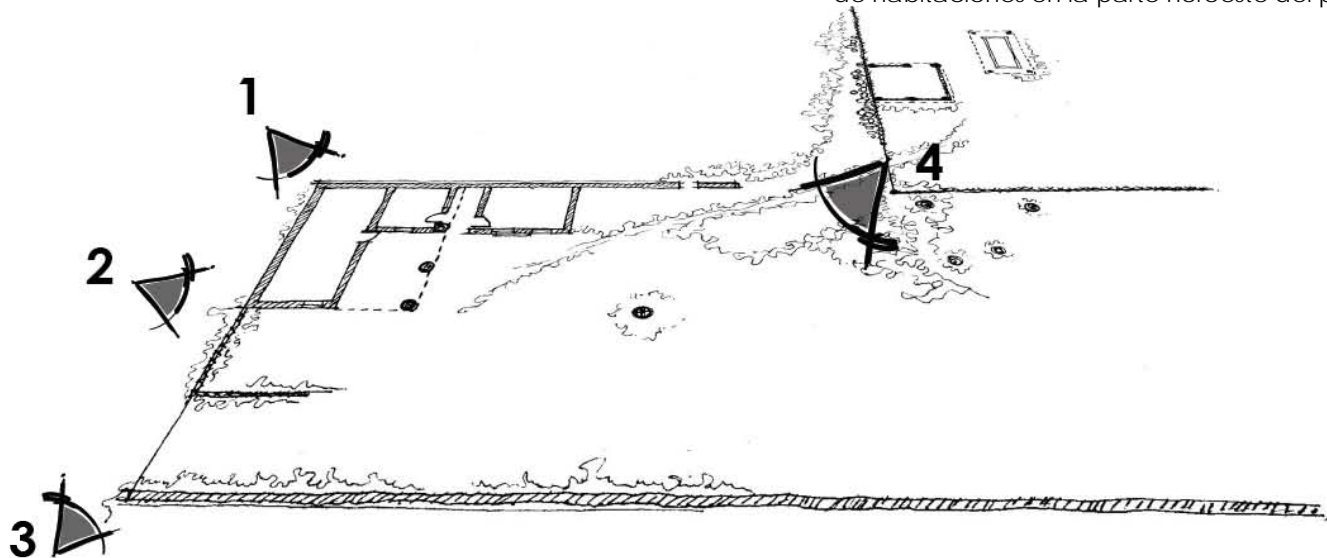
Vistas generales del predio. Fachadas interiores y exteriores.
